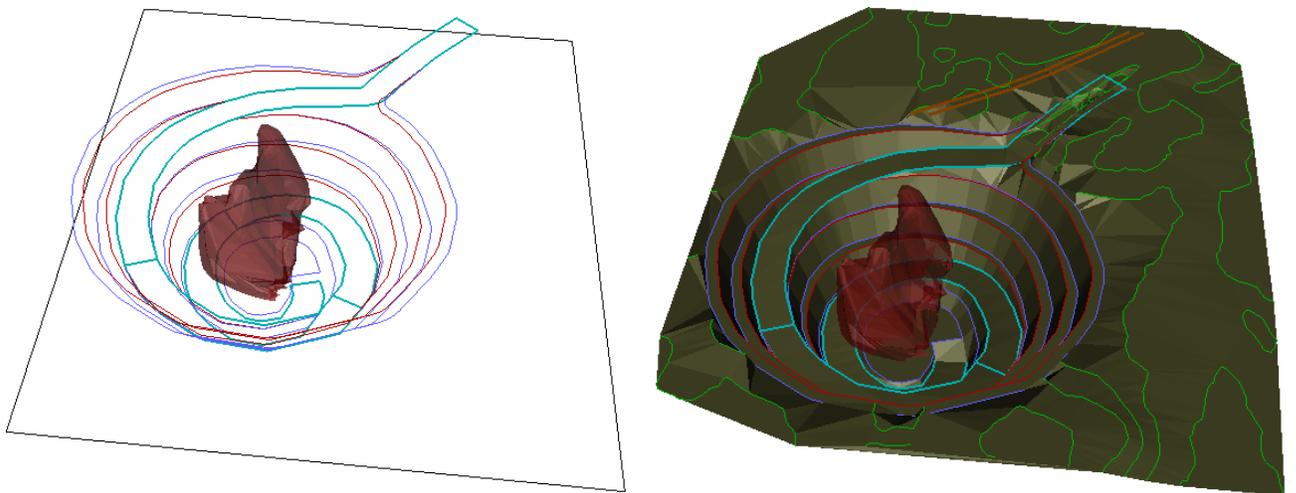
Vista 3D Variante II. Pit Tradicional (Espiral)
